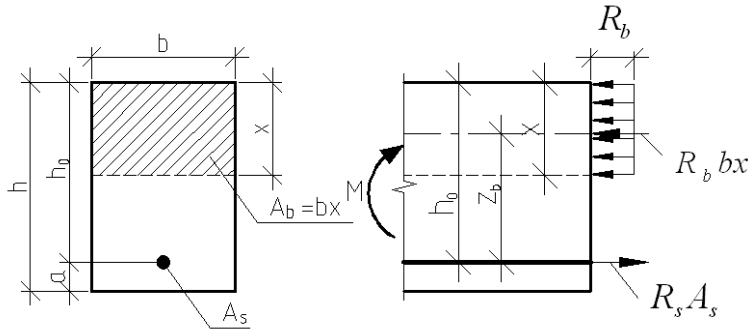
Прямоугольное сечение с одиночной арматурой и схема усилий.
